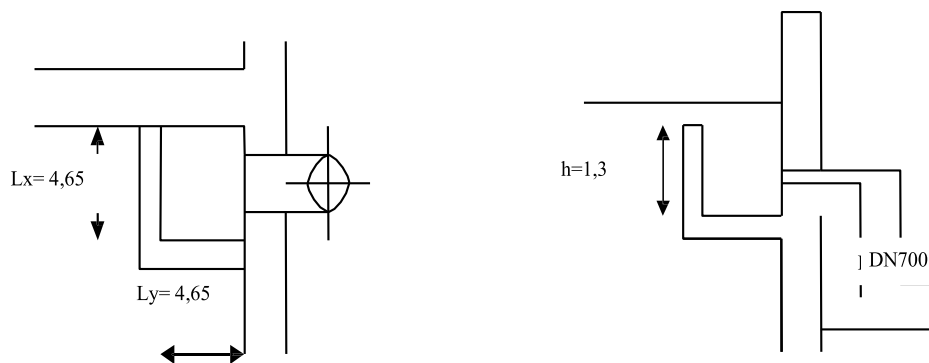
coupe en plan et en travers du trop-plein DN700.
